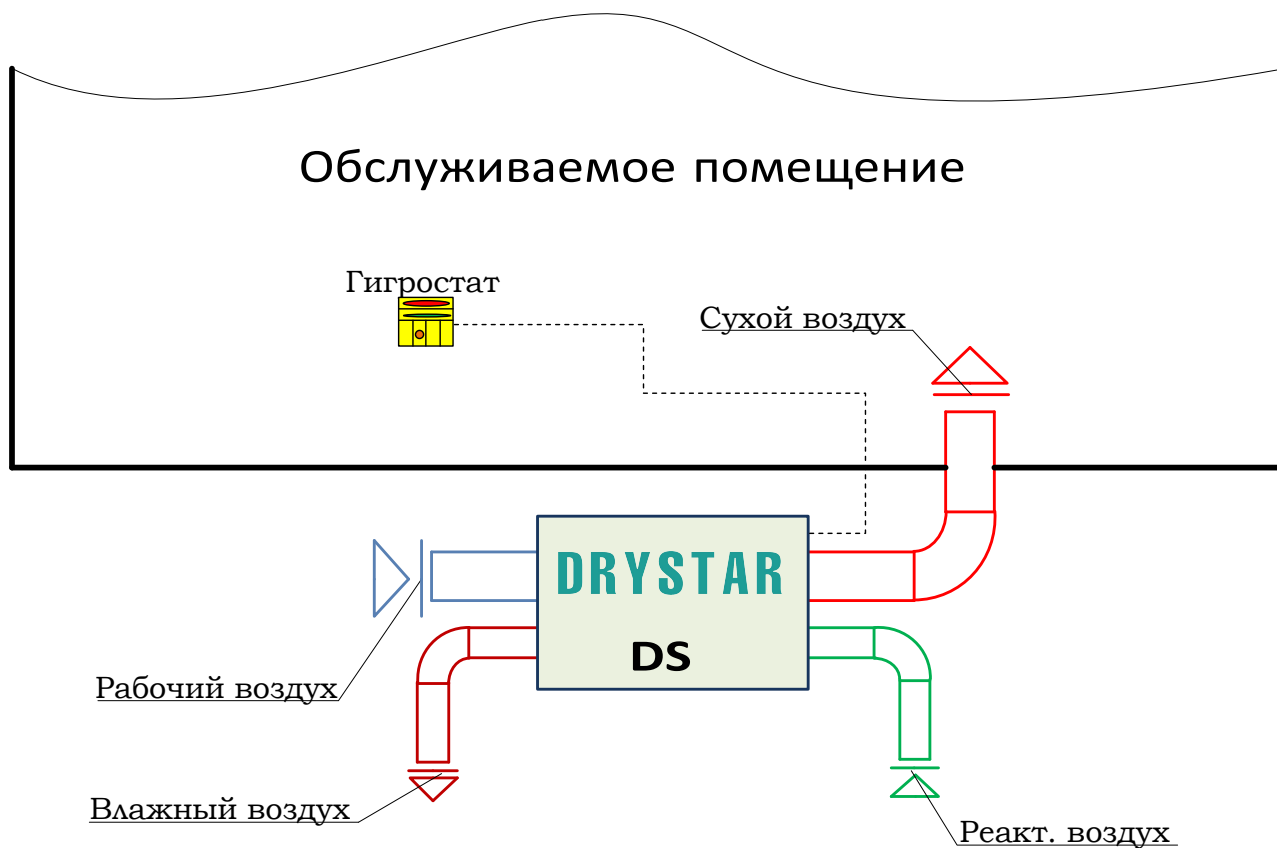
Работа осушителя по «открытой» схеме (наружное исполнение)
